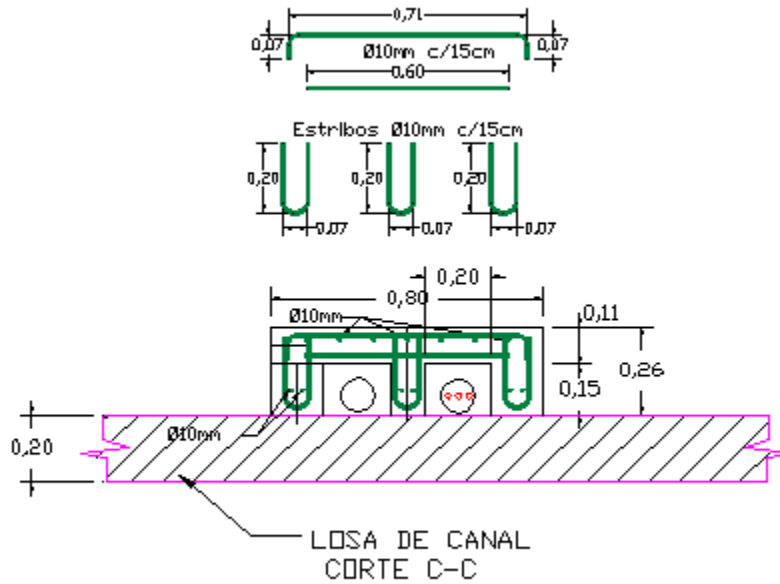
b: Corte- viga alojamiento final- despiece armadura. EDET RD-L.
